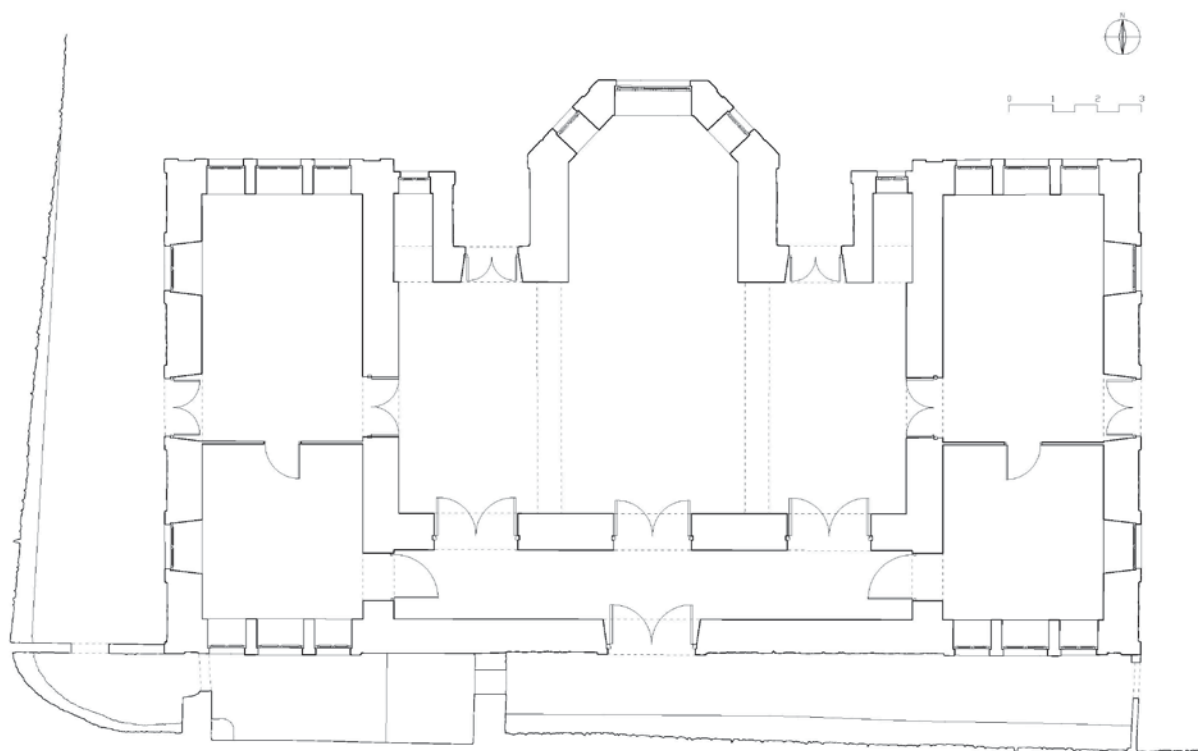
Plano sección horizontal planta baja. Estado original. Escala gráfica.
